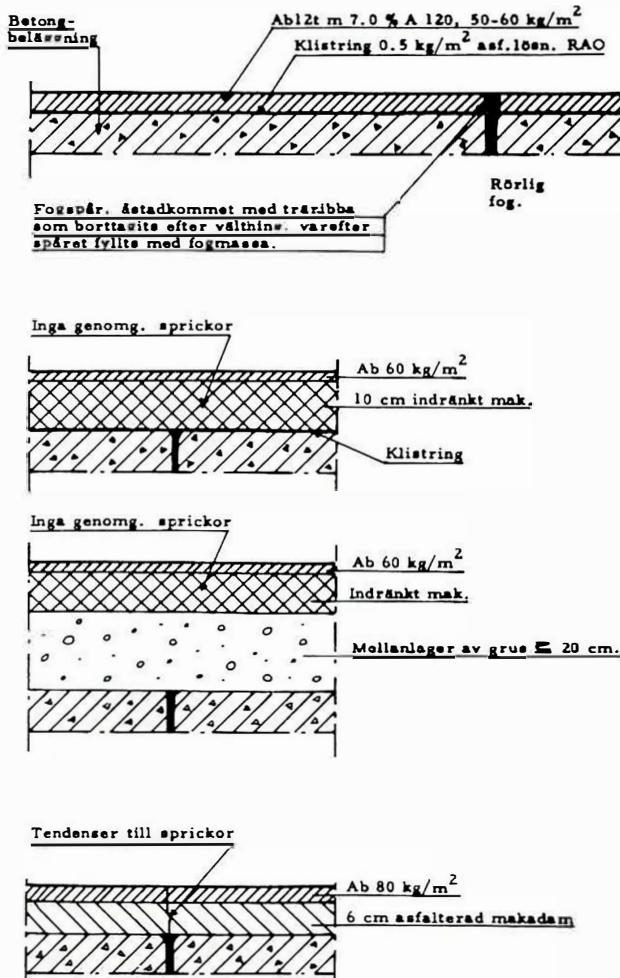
Exempel på utföranden av asfaltbeläggningar på betongbeläggningar på vägar och flygfält.
